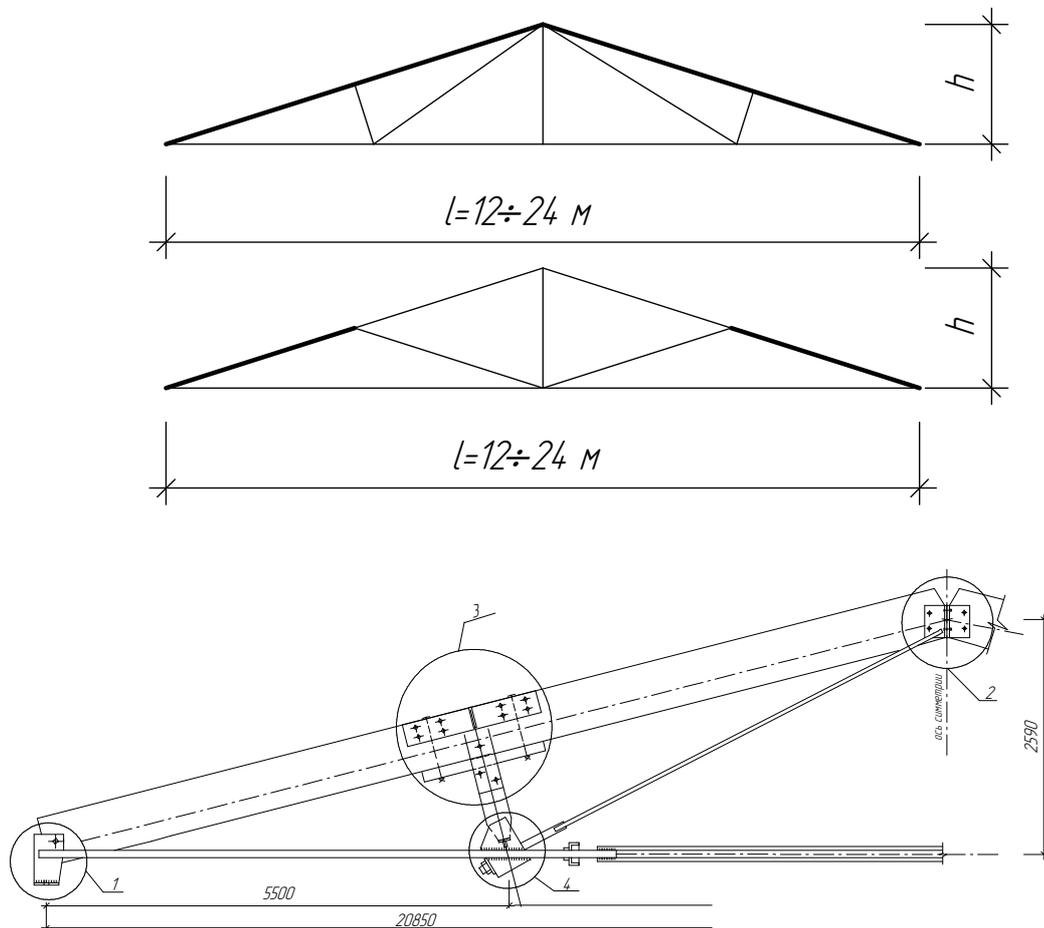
Схемы треугольных металлодеревянных ферм с клееным верхним поясом
